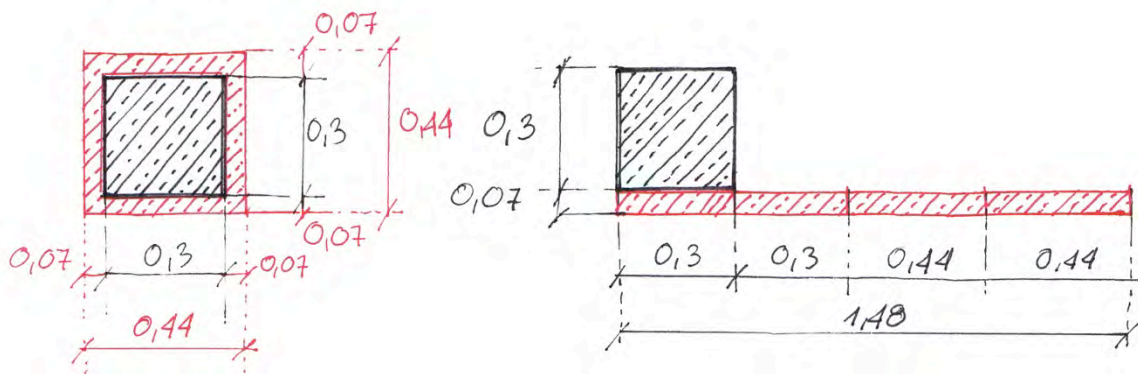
Vertikale Elemente , Neu - Bestand Beton Stütze
